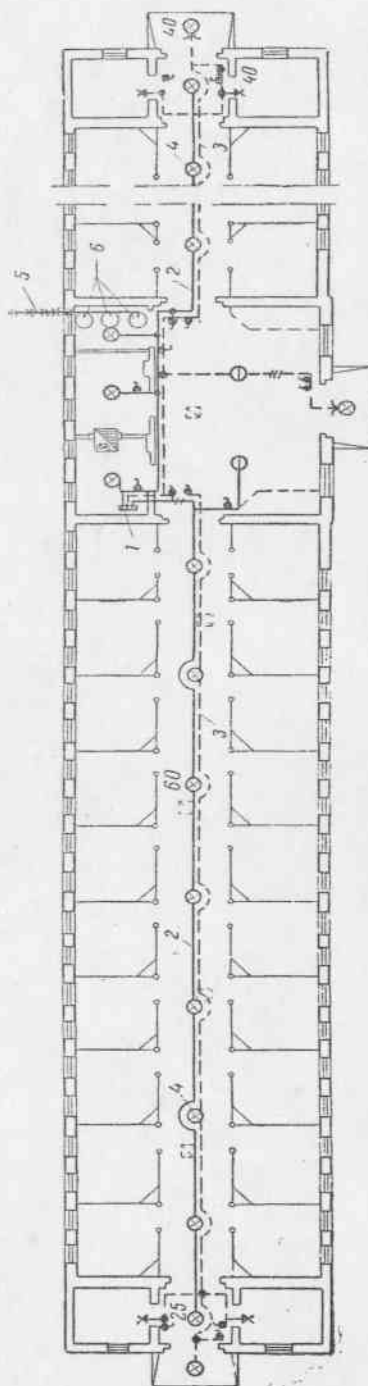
План конюшни на 40 голов тренировочного молодняка со схемами электроосвещения и водопровода: 1—групповой питом; 2—сеть рабочего освещения; 3—сеть дежурного освещения; 4—арматура полугерметическая; 5—ввод от наружной водопроводной сети; 6—бочки для воды.
